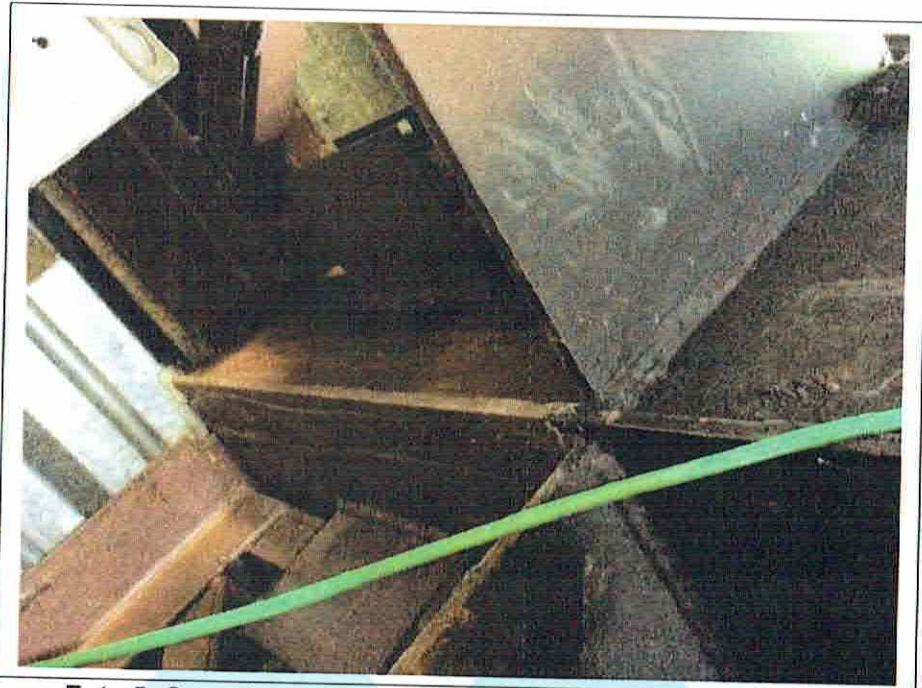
Celosías hacen la labor de soporte para los sistemas de losa, elementos y conexiones sin falla. Sistema de losacero en losa de azotea.
